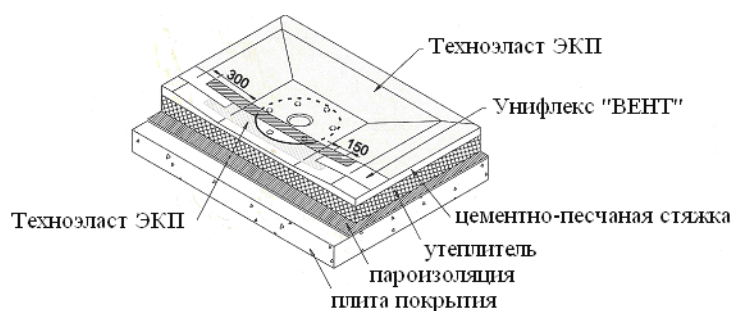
Схема установки водосливной воронки в плоскости кровли
